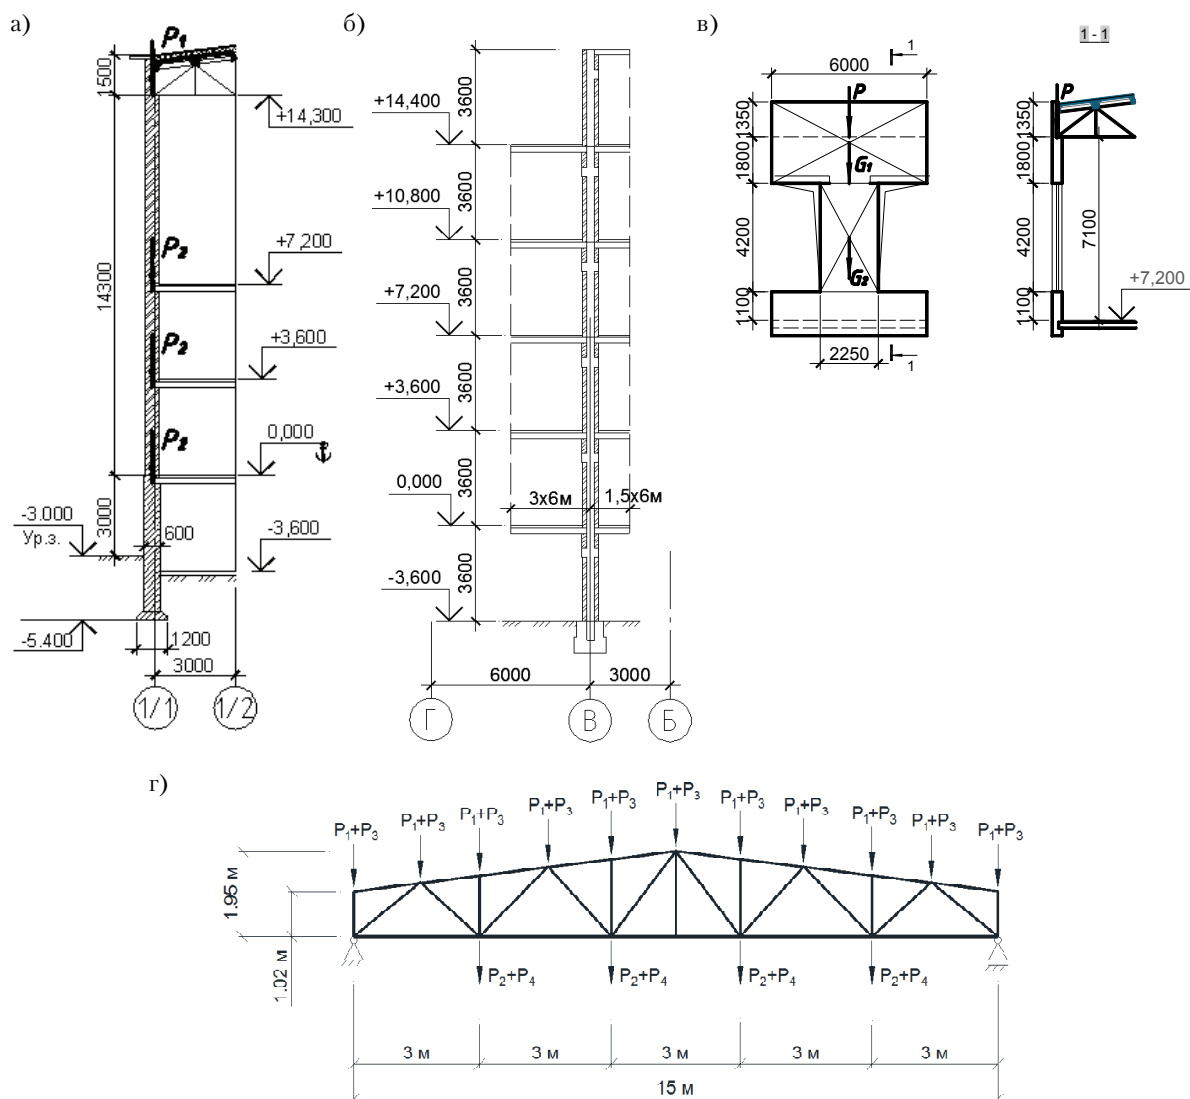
Расчетные схемы конструкций здания: а) стена; б) колонна; в) стена актового зала (выше отм. +7,200); г) ферма.
